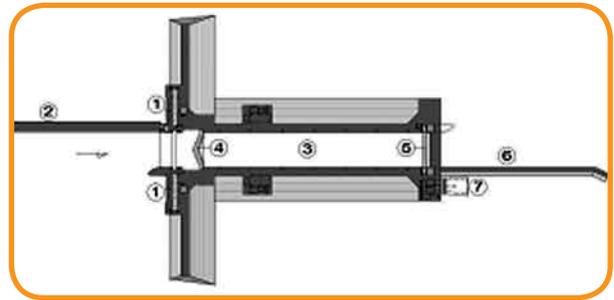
Planta Esquemática da Eclusa I, onde: 1 – Tomada d'Água; 2 – Muro Guia de Montante; 3 – Câmara; 4 – Comporta de Montante; 5 – Comporta de Jusante; 6 – Muro Guia de Jusante; e, 7 – Bloco de Esvaziamento.
